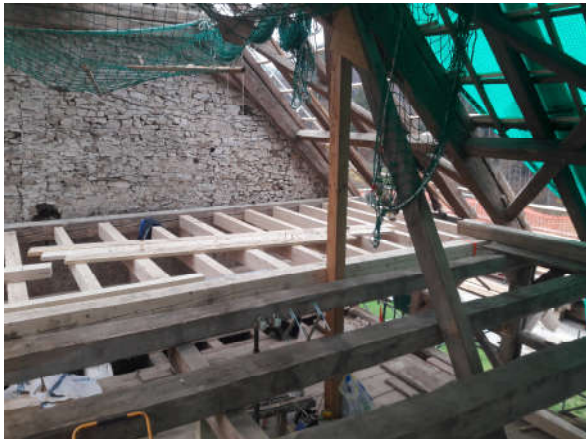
Die Balkenlage für den befahrbaren Dachboden wird montiert.
